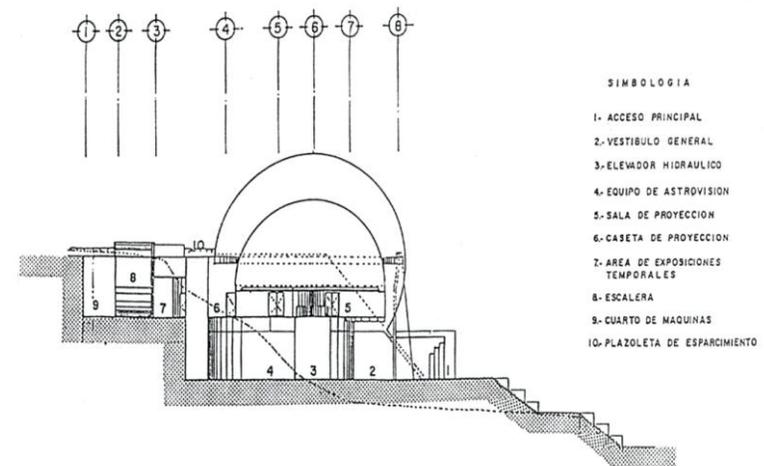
Corte arquitectónico, planetario de Ciudad Victoria
